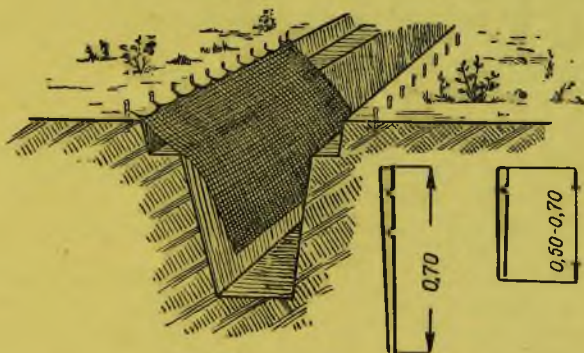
Перекрытие рва откидным фартуком из маскювра
